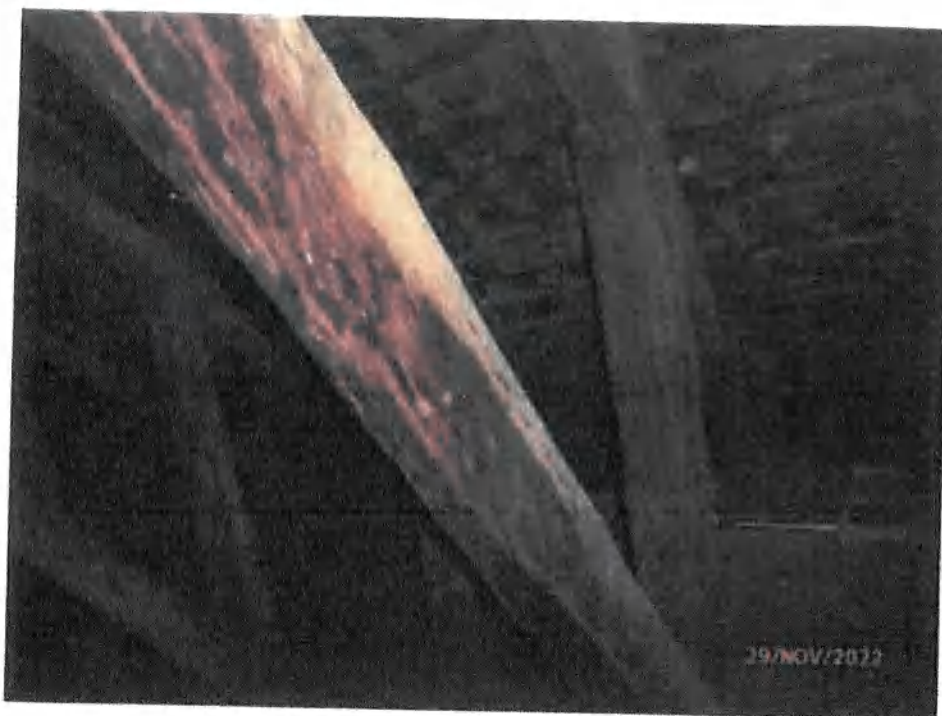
Durchfeuchteter Dachsparren (Undichte Dacheindeckung)
